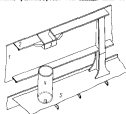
Стандарт и брус для испытаний стенок из бруса
